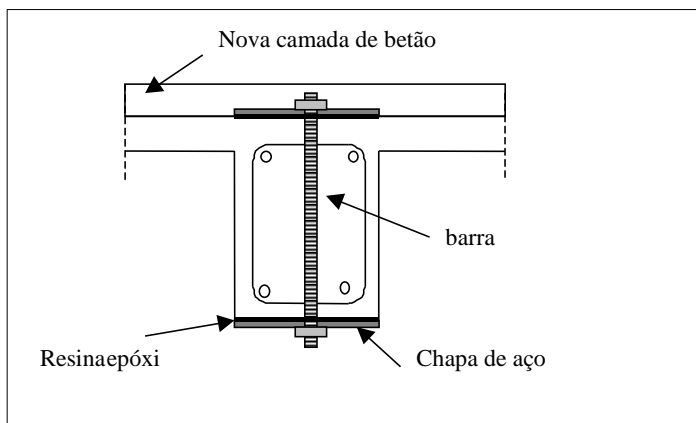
Reforço de vigas com chapas metálicas interligadas por barras [24].
